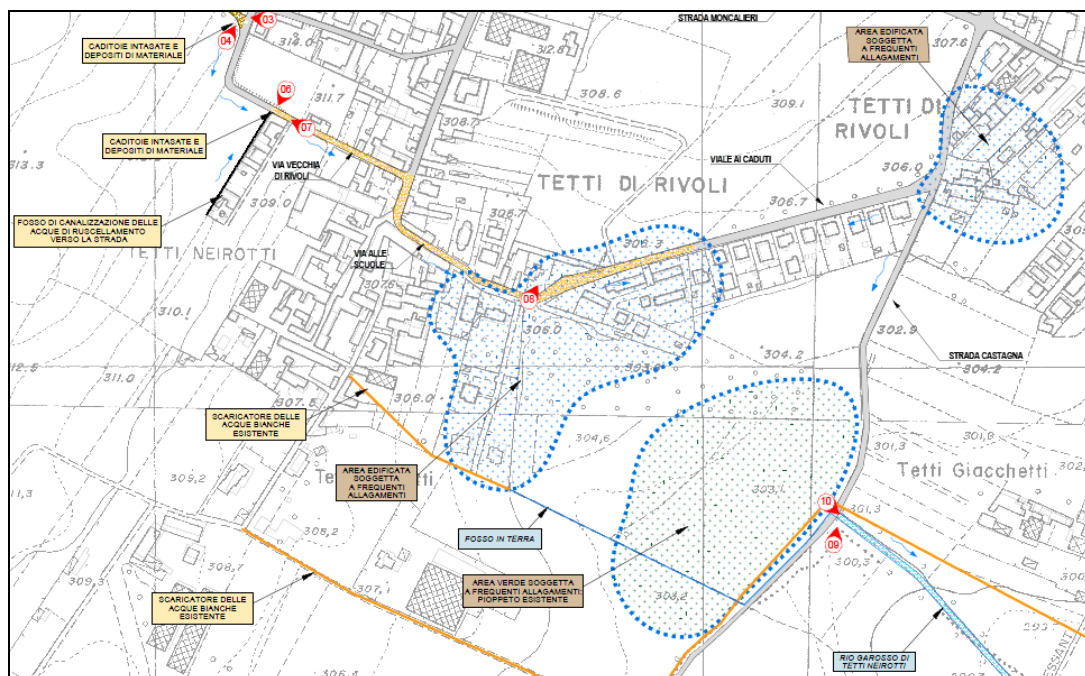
Stralcio dall'elaborato 10 - *Planimetria stato attuale e quadro delle criticità* (SRIA S.R.L., 2018).
